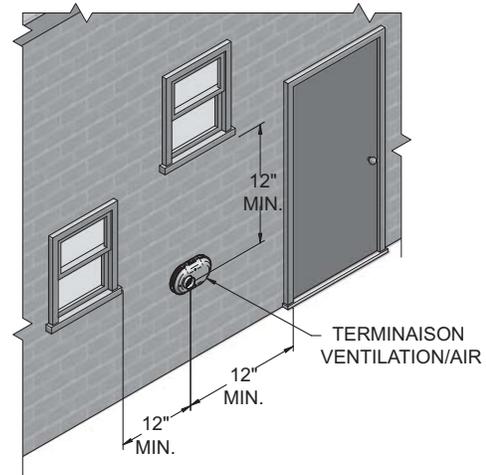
D Alternar la disposition de ventilation SS Terminaison d'air murale classique en acier inoxydable et ventilation avec raccords fournis sur place, utilisant une entrée capot
